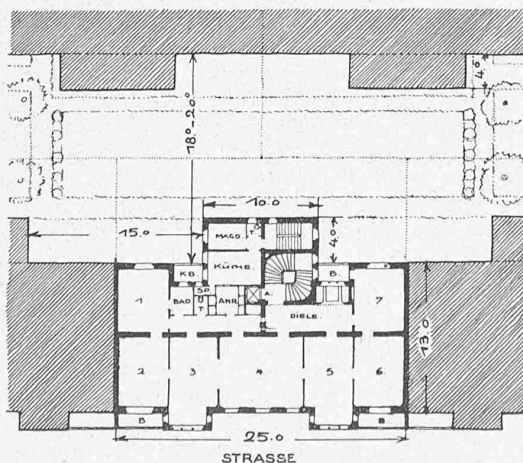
Grundriss-Typ, 1:600 (in Abb. 7 kreuzweise schraffiert).
